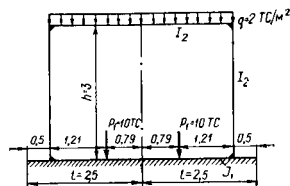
Прямоугольная железобетонная рама на упругом основании:
